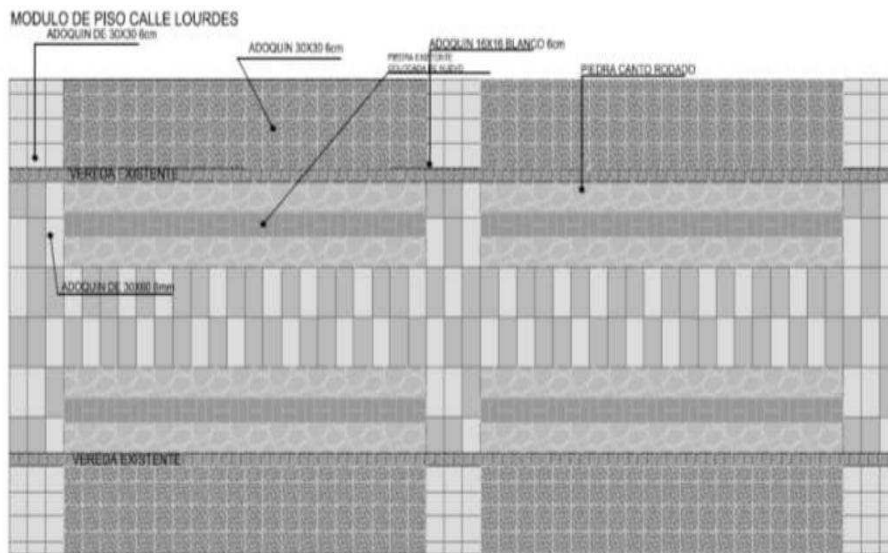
Lamina Proyecto de Regeneración Urbana, Detalle de piso calle Lourdes.
